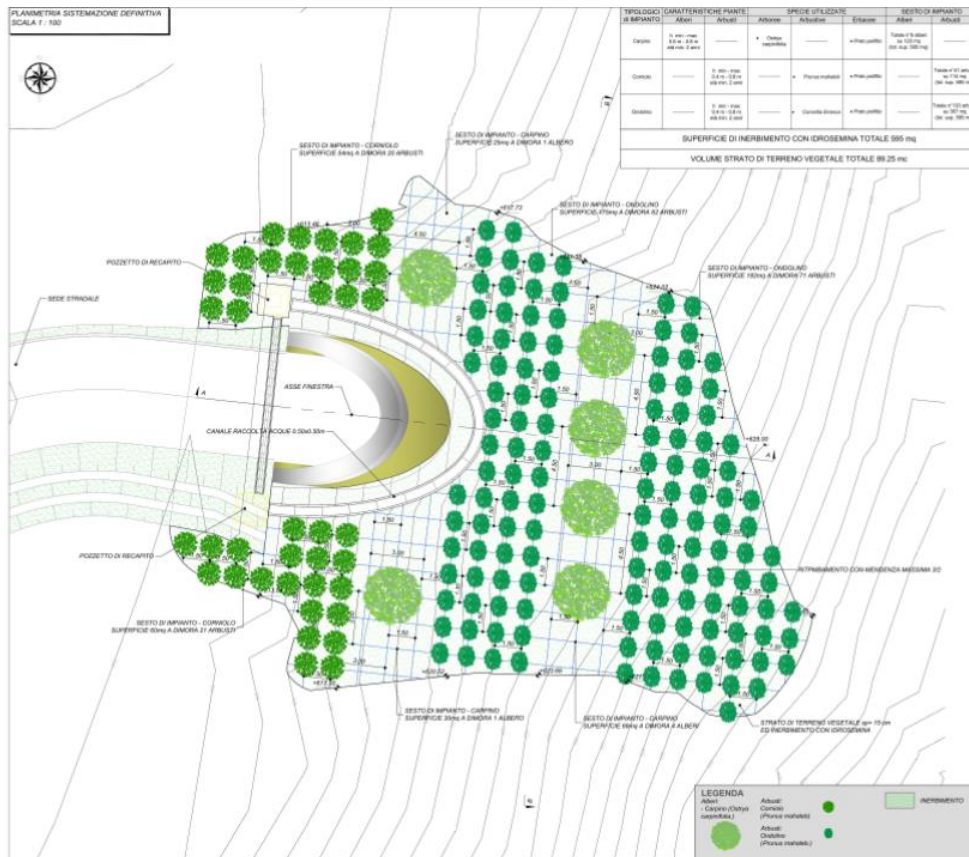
Opere a verde – Planimetria di progetto imbocco della finestra di Chiasso.
